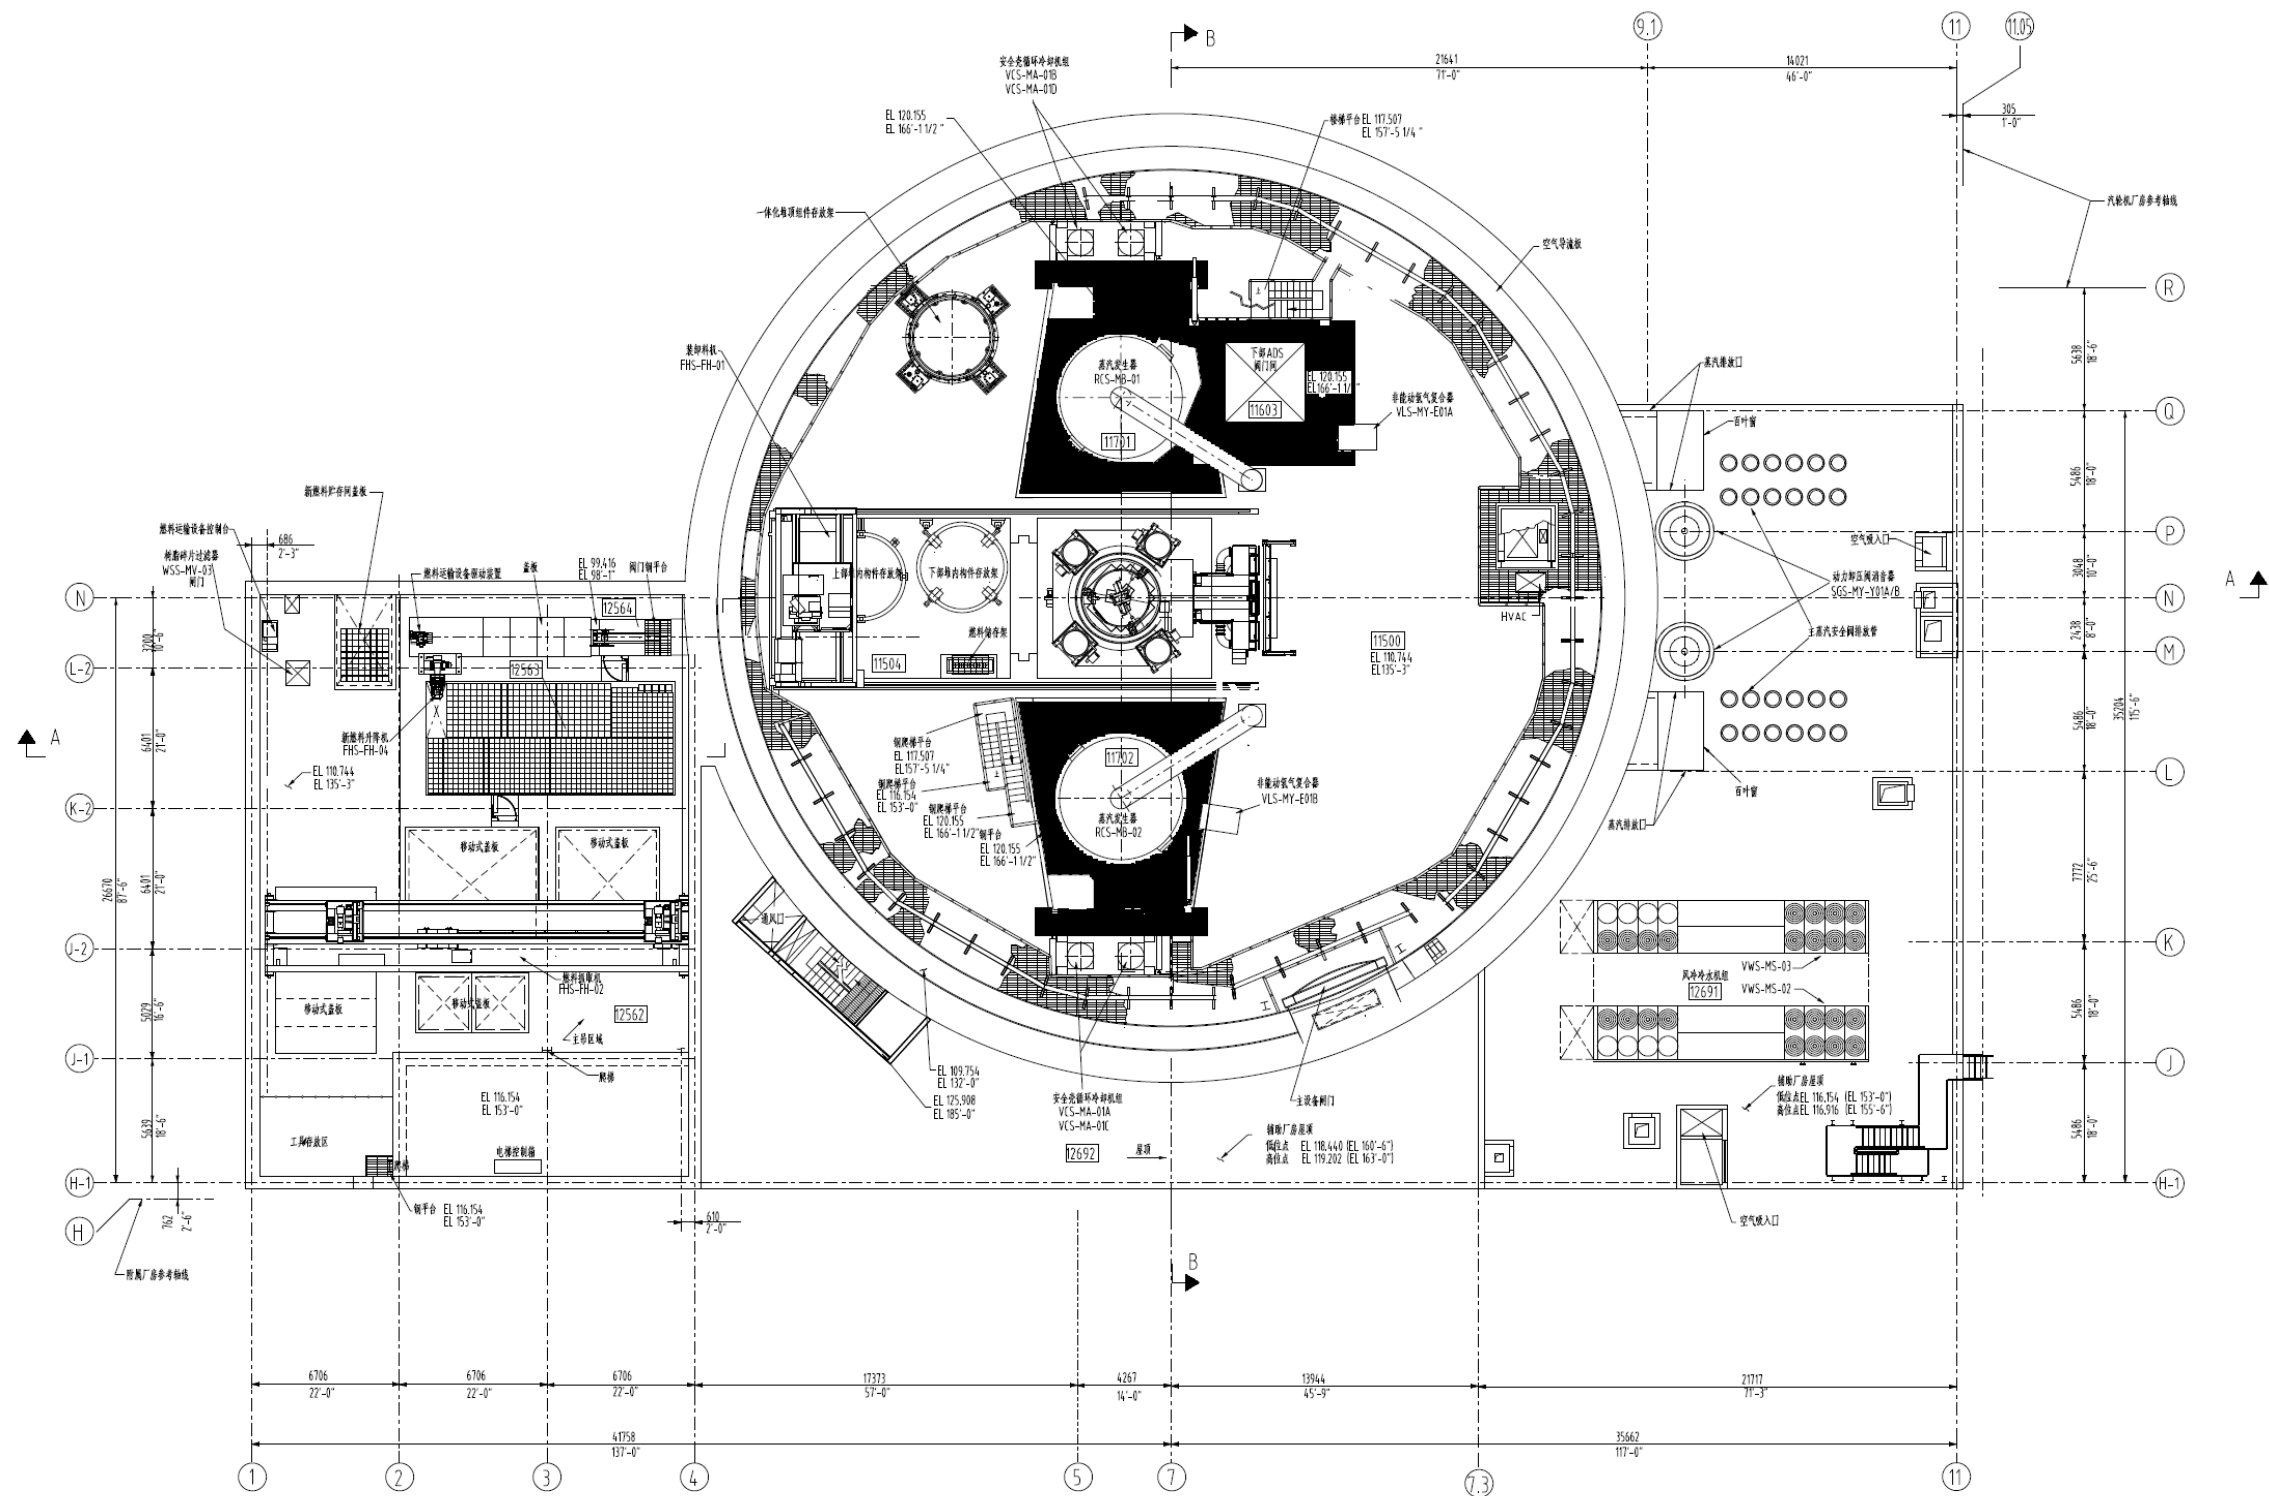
核岛厂房布置示意图 116.154m 及 118.440m
